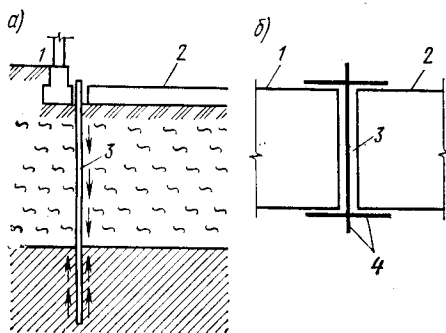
Устройство шпунтовой стенки (по Б. И. Далматову):
